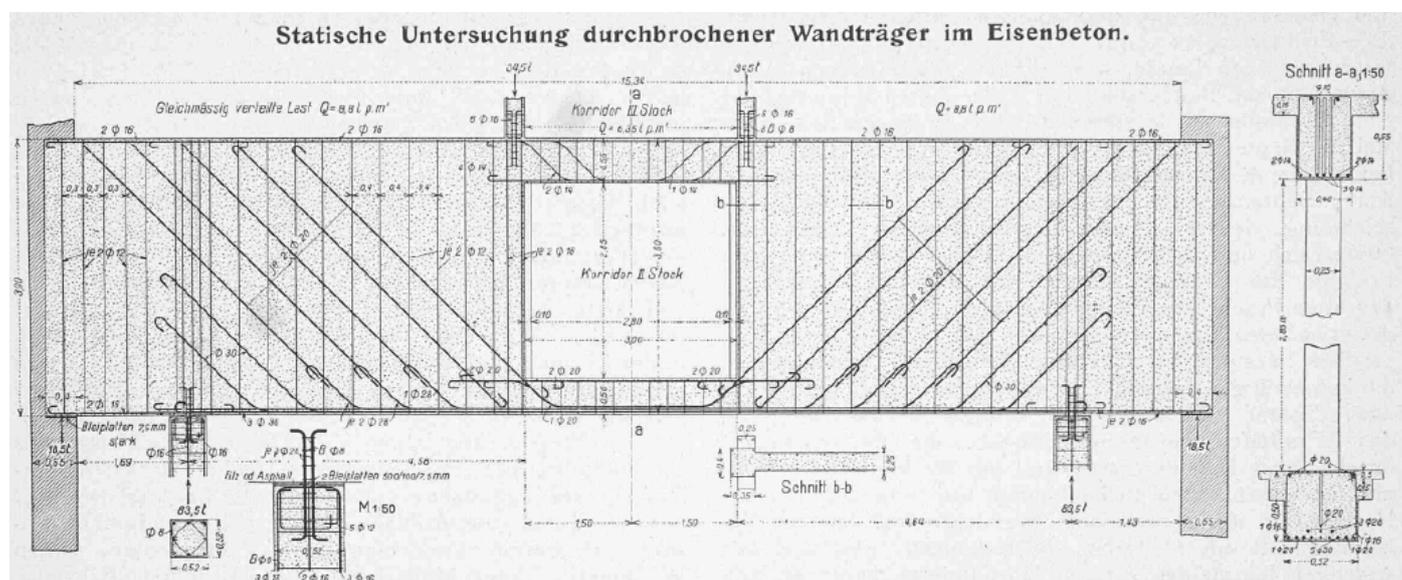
disposizione delle armature per una trave a forma di muro con apertura di [2].
